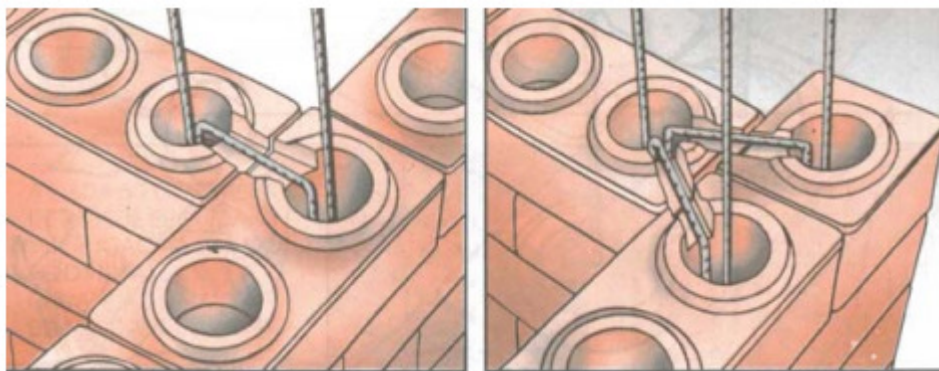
Detalhes das amarrações de encontro de paredes. Fonte: SAHARA (2009).
